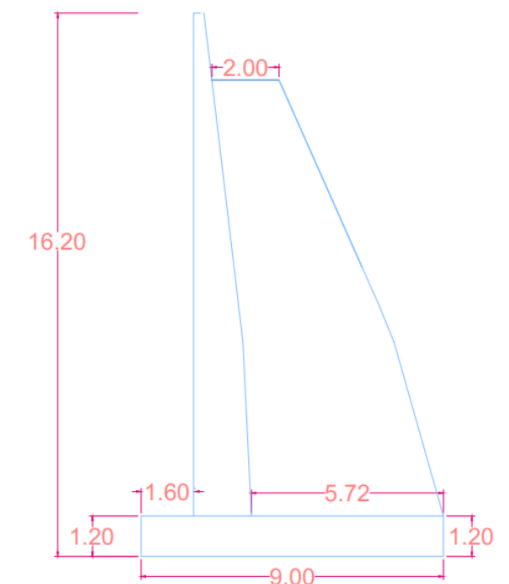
Dimensiones reales de la estructura construida (corte de la sección en estudio)
